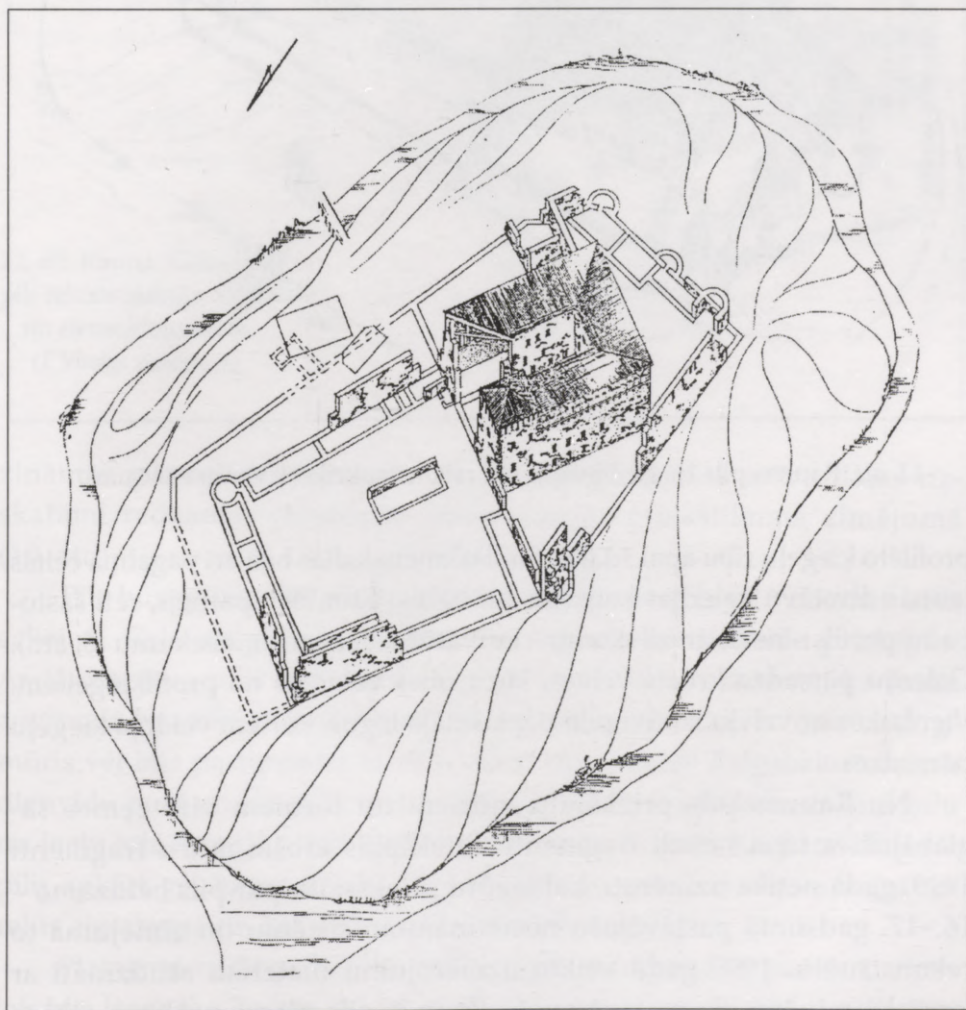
att. Raunas pils rekonstrukcija mūsdienu situācijas plānā (T. Vitolas zīmējums)
